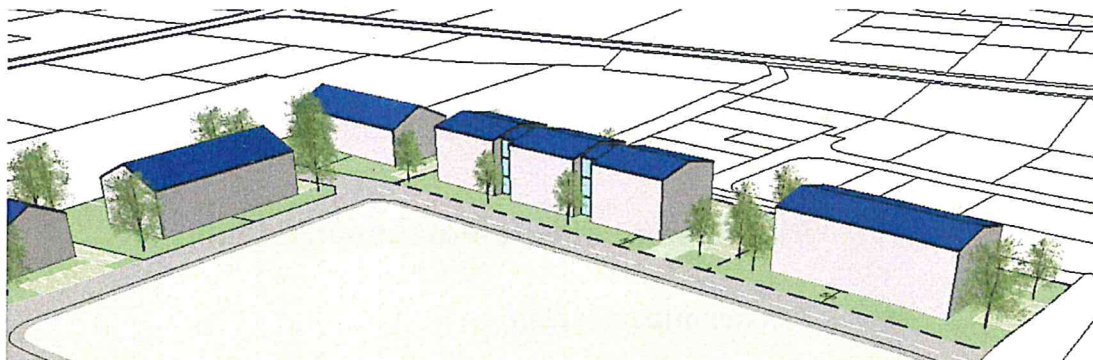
Städtebaulicher Entwurf der nördlichen Bebauung im WA 1:
